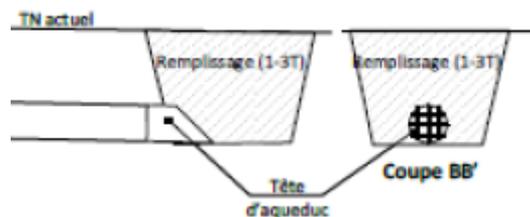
Coupe de principe du débouché en mer de l'ouvrage
